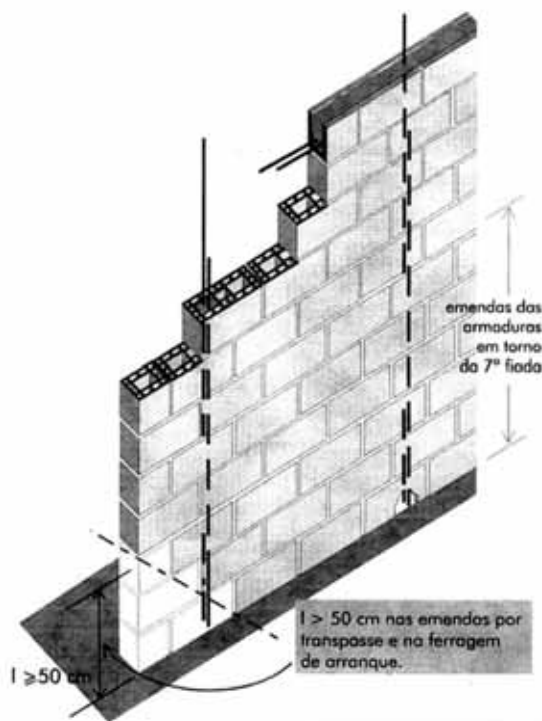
Detalhes alvenaria estrutural. Fonte: RAMALHO, M.A. & CORREA, M.R.S. *Projeto de Edifícios de Alvenaria Estrutural*. Editora PINI. São Paulo, 2003
